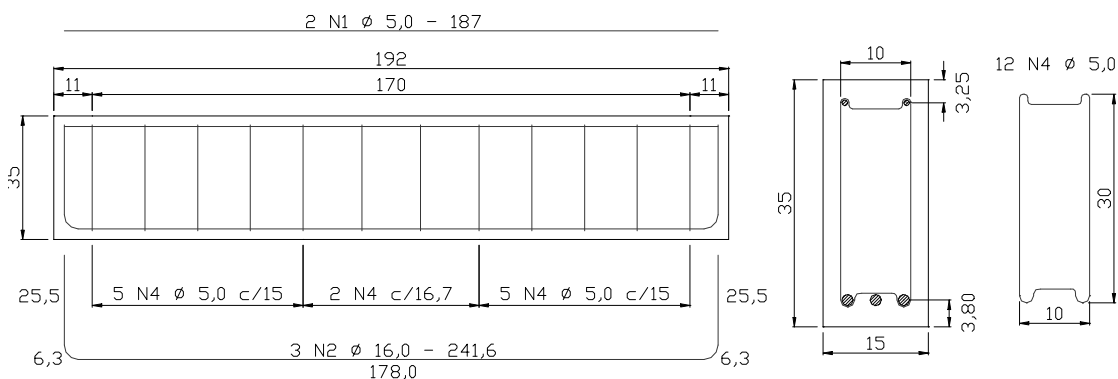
Detalhamento das armaduras das vigas do grupo VA (cotas em cm)
